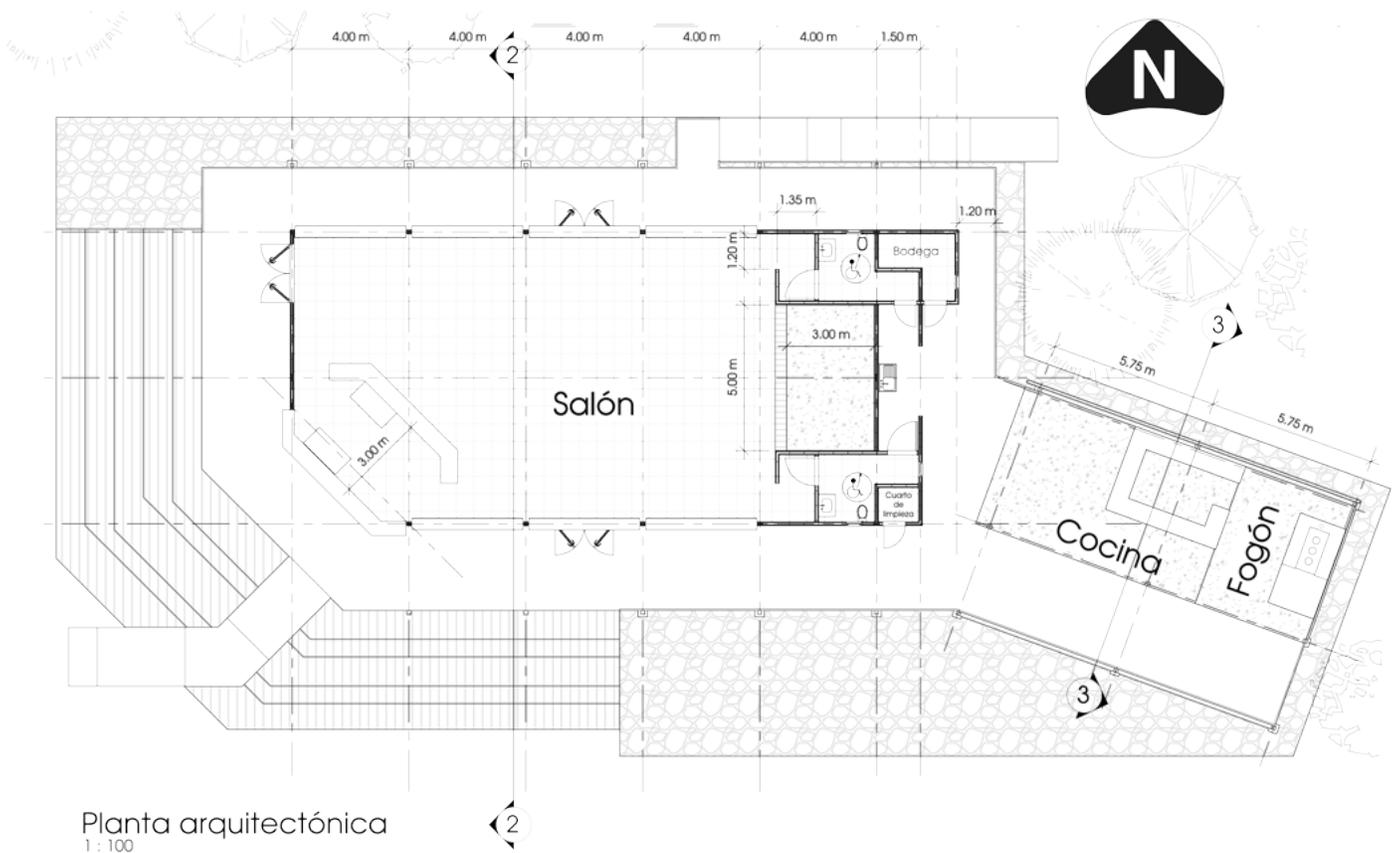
Planta de la propuesta de diseño del Salón Comunal para Parcelas de Rancho Coco. Fuente: Elaboración propia.
